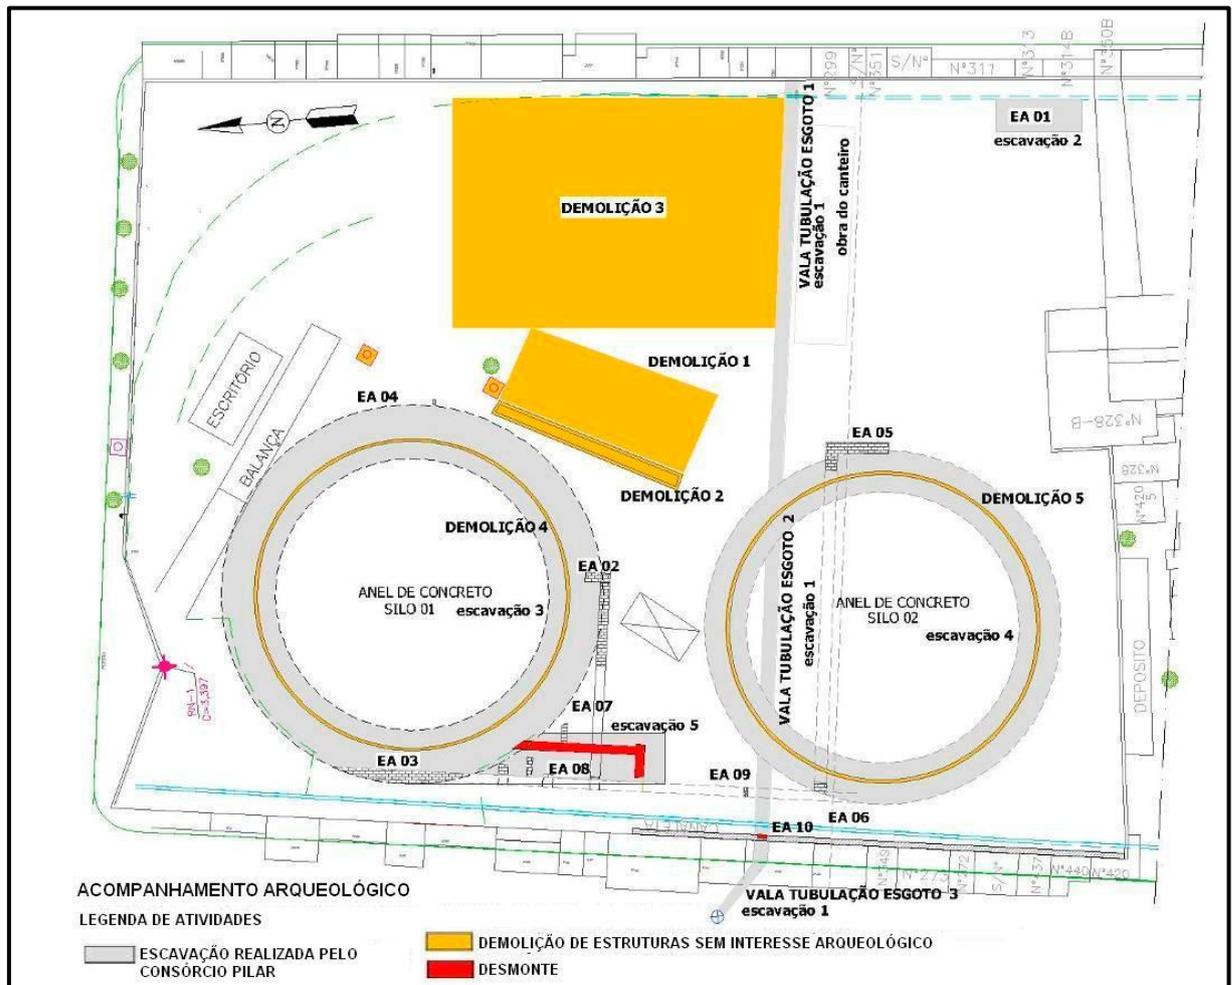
Trecho da quadra 40 onde foram realizadas as primeiras intervenções com as estruturas arqueológicas (EA's) encontradas, locais de escavação e de demolição plotados. Fonte: FUNDAÇÃO SERIDÓ, 2010a, p. 22.
